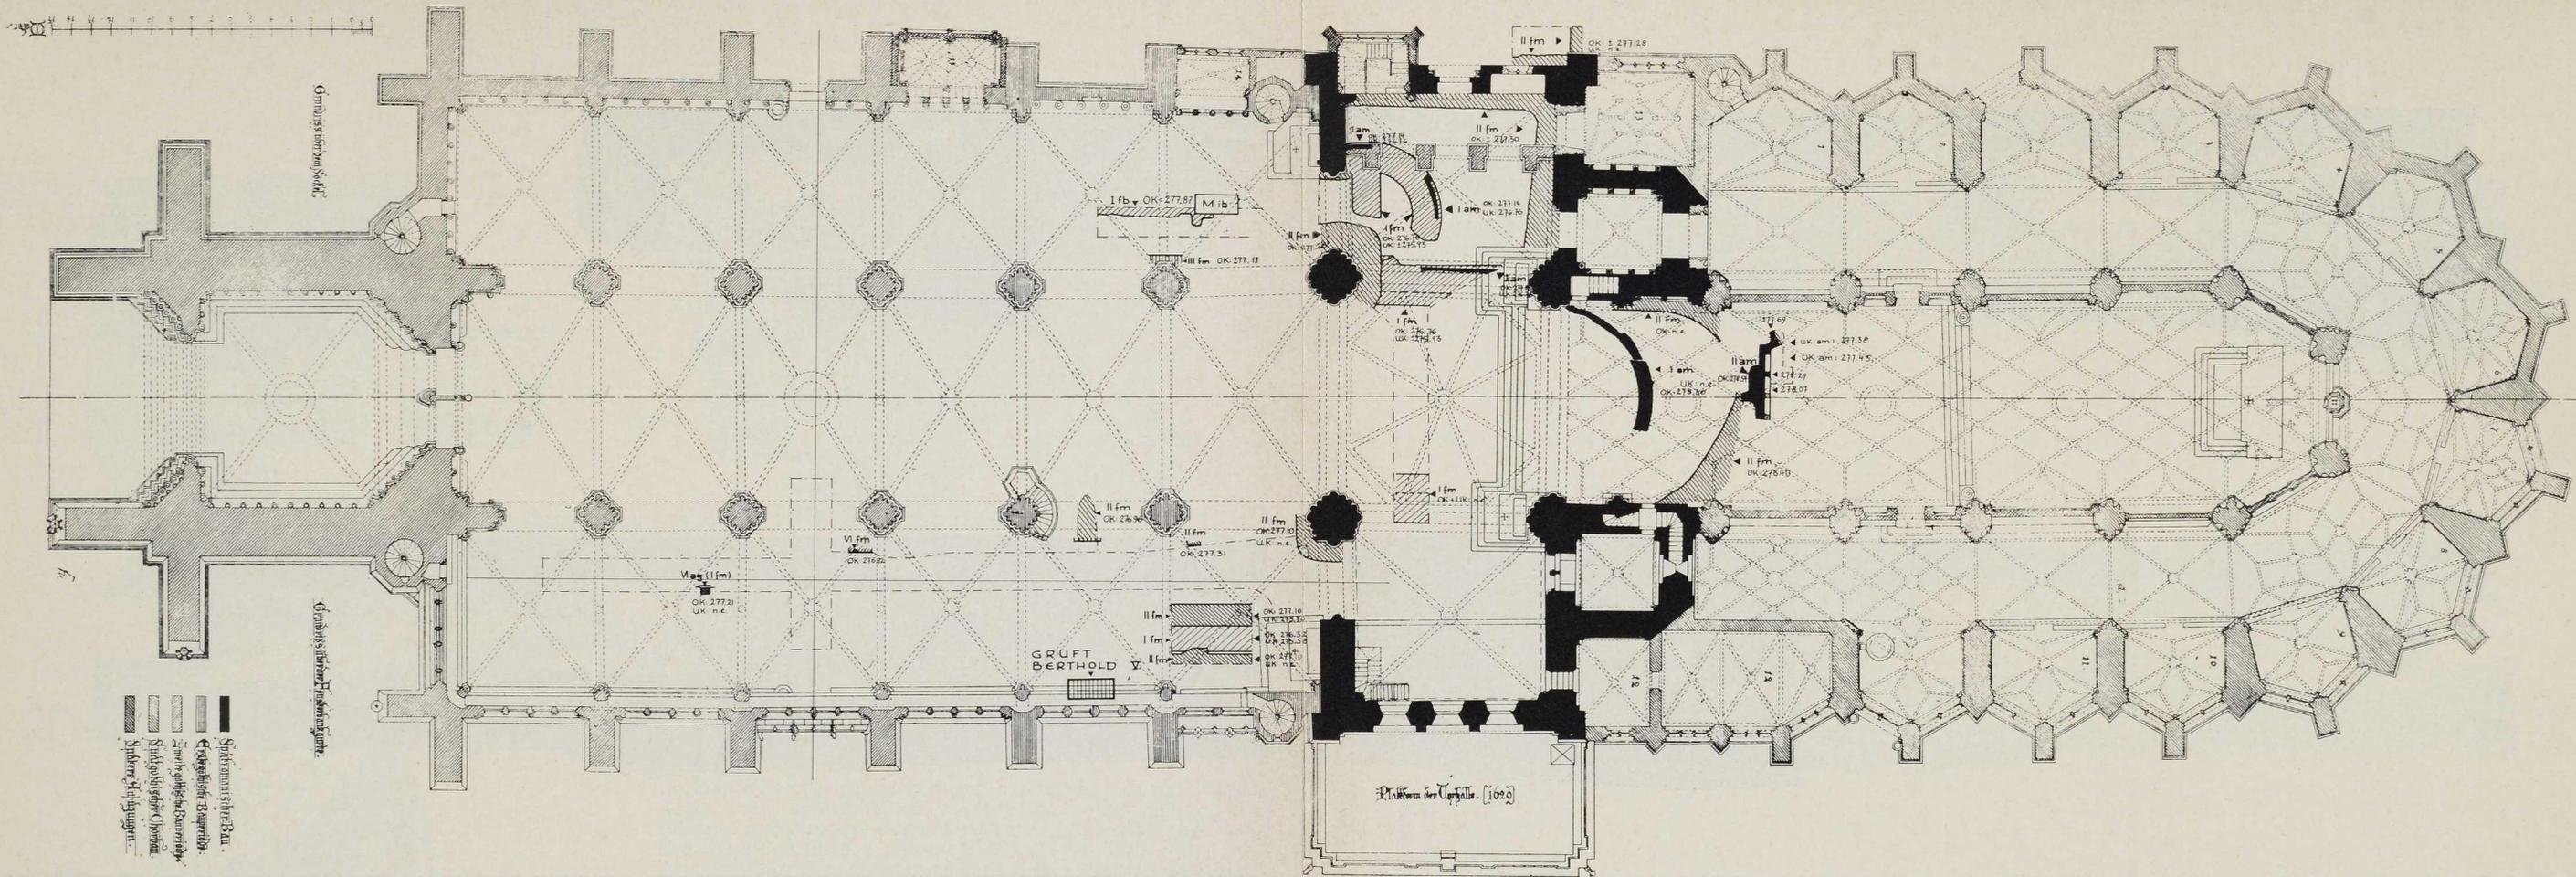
Freiburg i. Br. Münster — Grundriß der Münsterbauhütte mit eingetragenen Grabungsbefunden aus den Jahren 1920—1969
